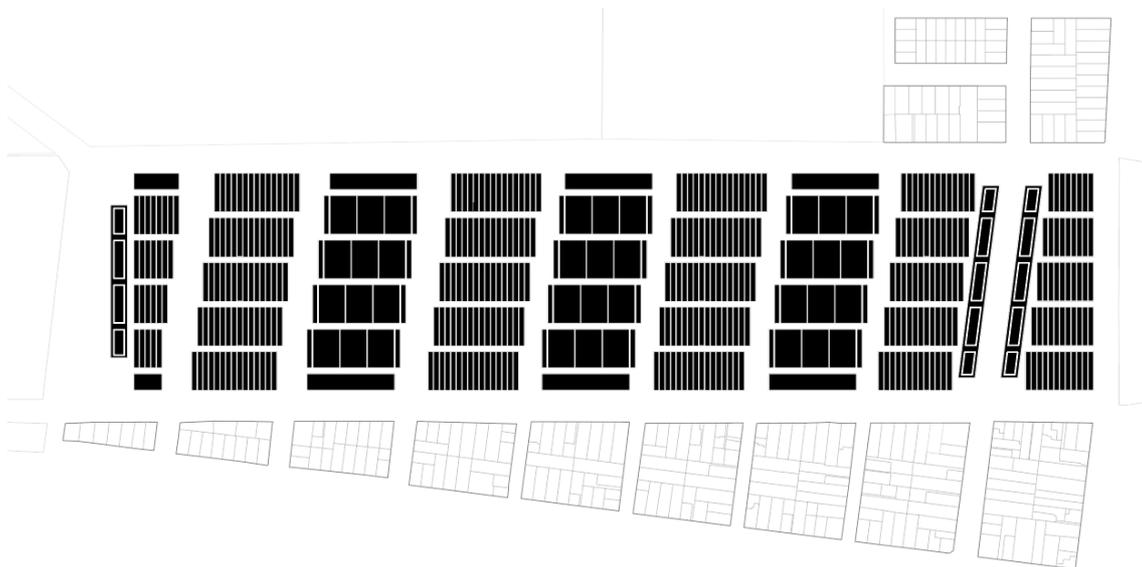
Fig. X. Estructura parcelaria. AUP en Villa Constitución. Fuente: elaboración propia
